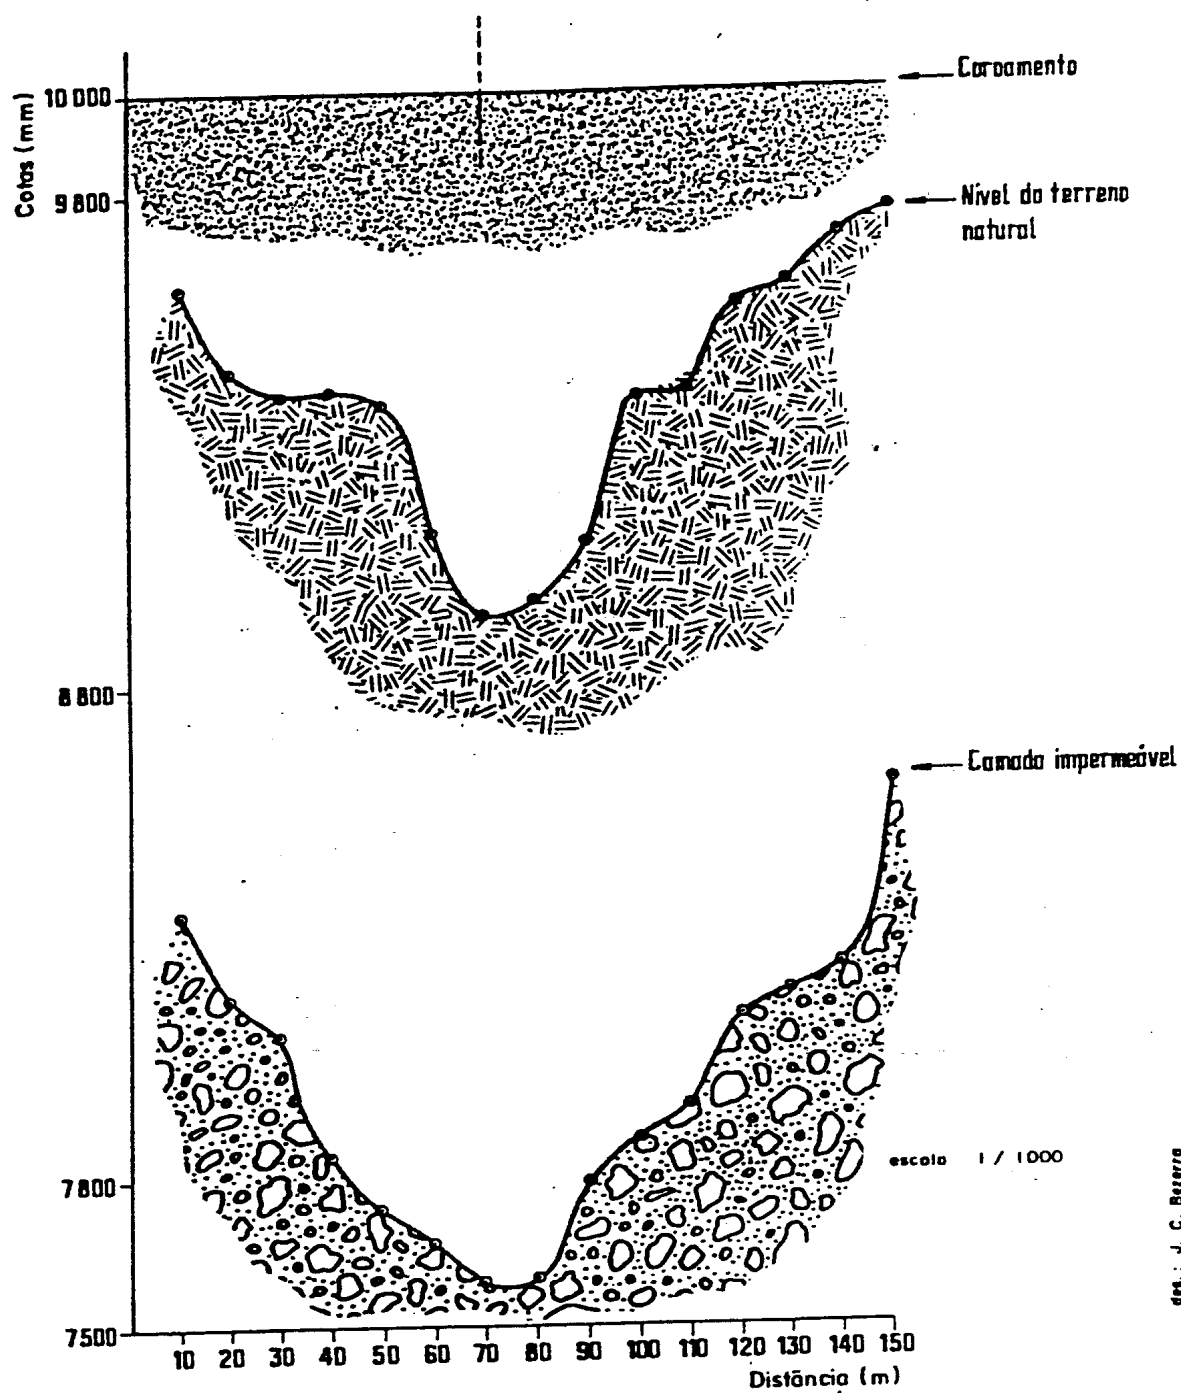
Planta planialtimétrica das barragens subterrâneas tipo CPATSA.
